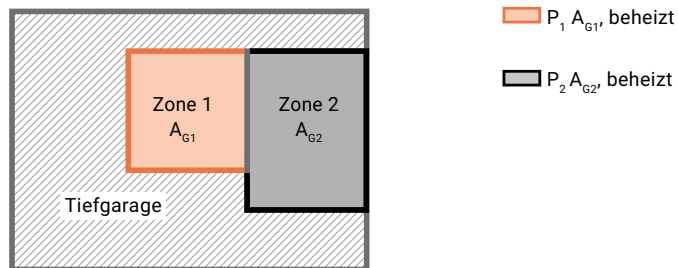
Grundrisse UG: erdberührte Bodenplatte einer Tiefgarage
